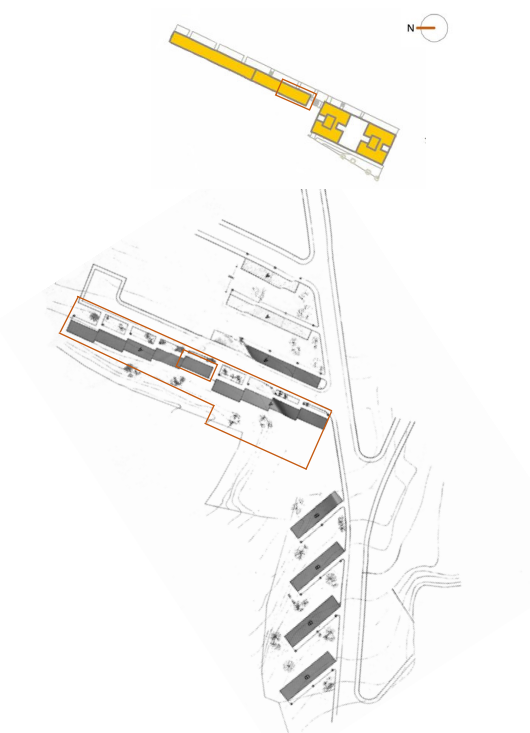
Plano de situación original, en planta, del edificio ubicado en la Rúa Moaña-Coia, 5. Se complementa con una imagen de la vista en planta de la parcela en la que se sitúa el presente edificio (fotografía de autoría propia).
